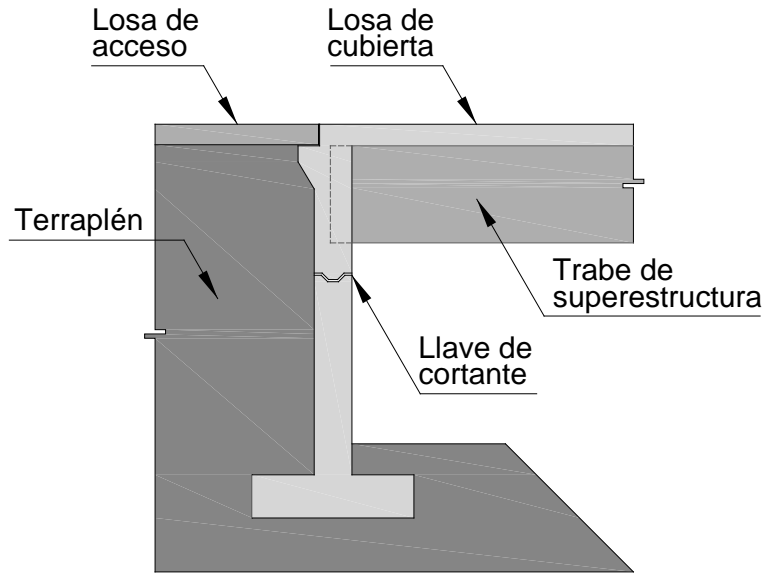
Estribo de puente integral – estribo con llave de cortante
